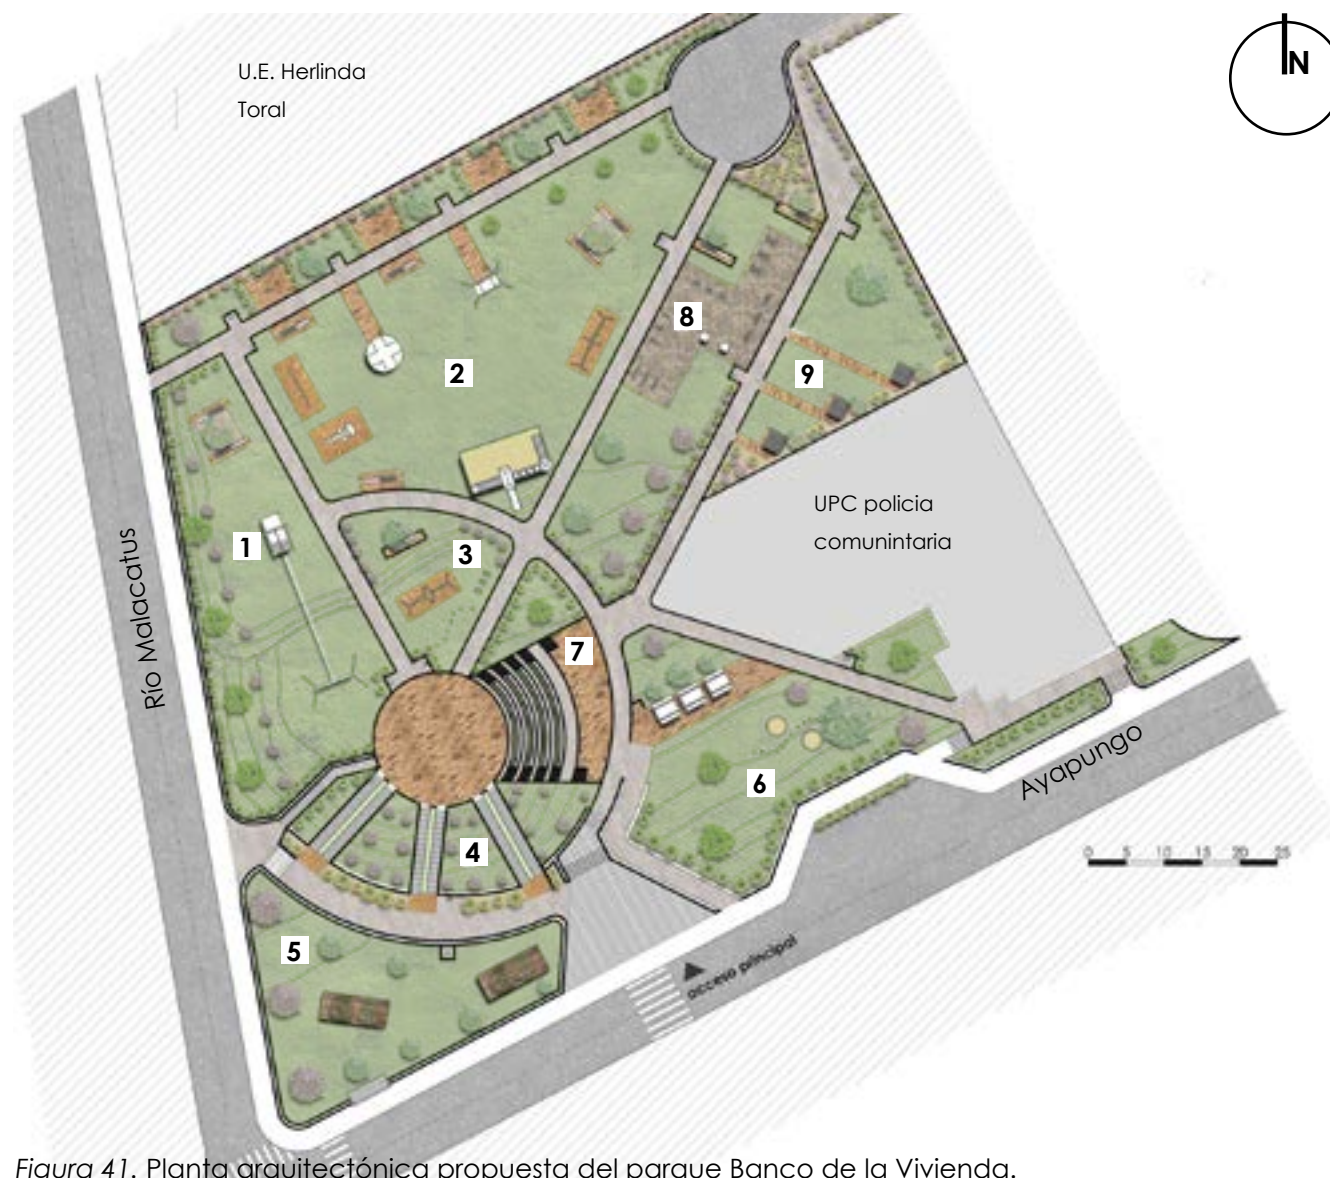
Planta arquitectónica propuesta del parque Banco de la Vivienda.
